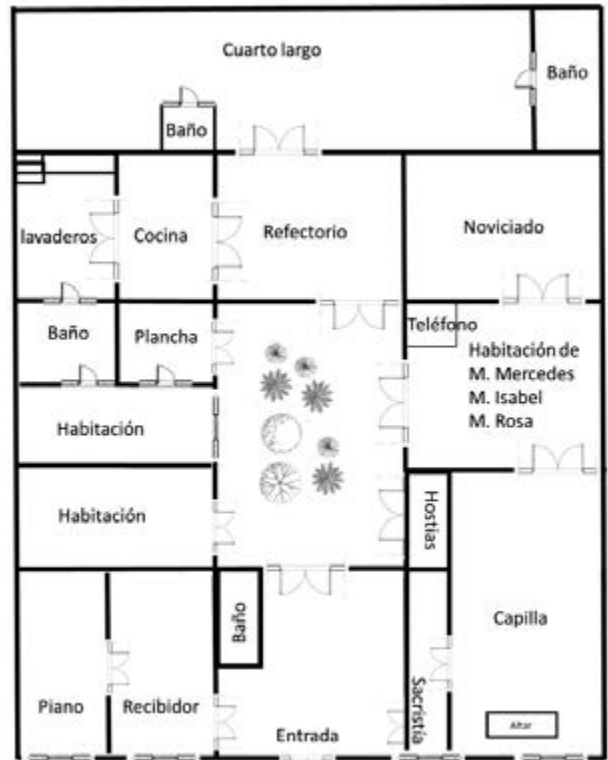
Plano aproximado de lo que fue la casa de Garrido.
